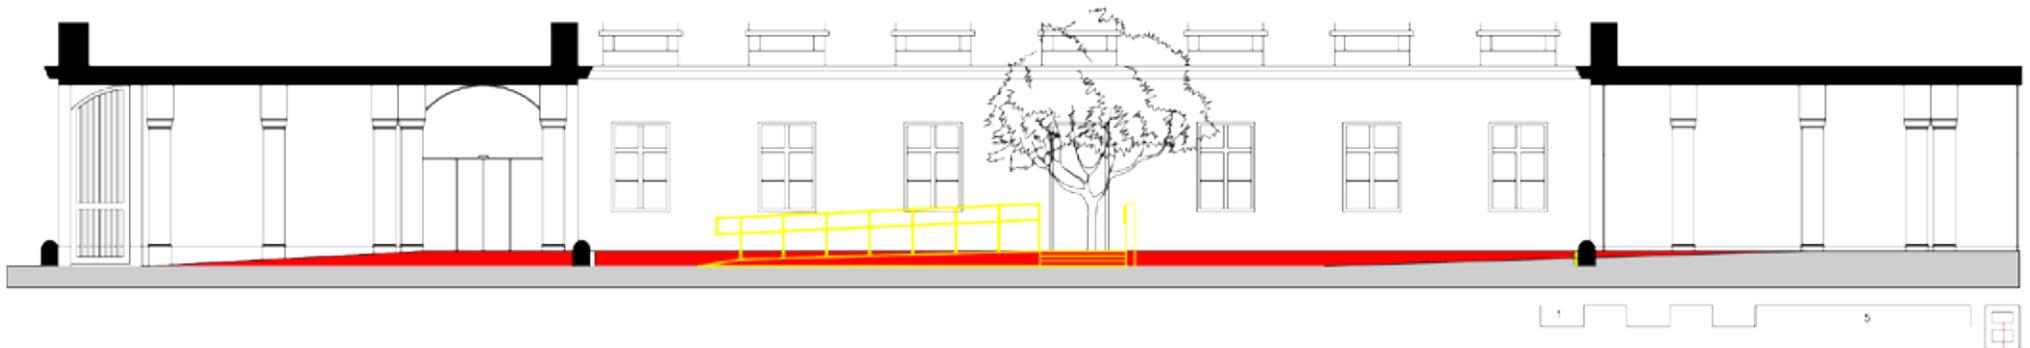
Schnitt durch die neu zu errichtende Rampe, den ersten Hof und den zweiten Durchgang ins Gebäude mit der abzureißenden bestehenden Rampe (gelb: Abriss)
